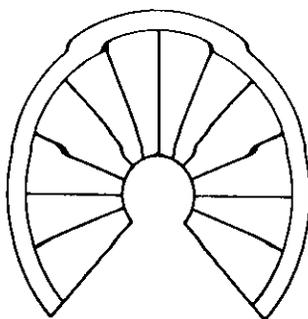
Escada Circular alojada em espaço cilíndrico
